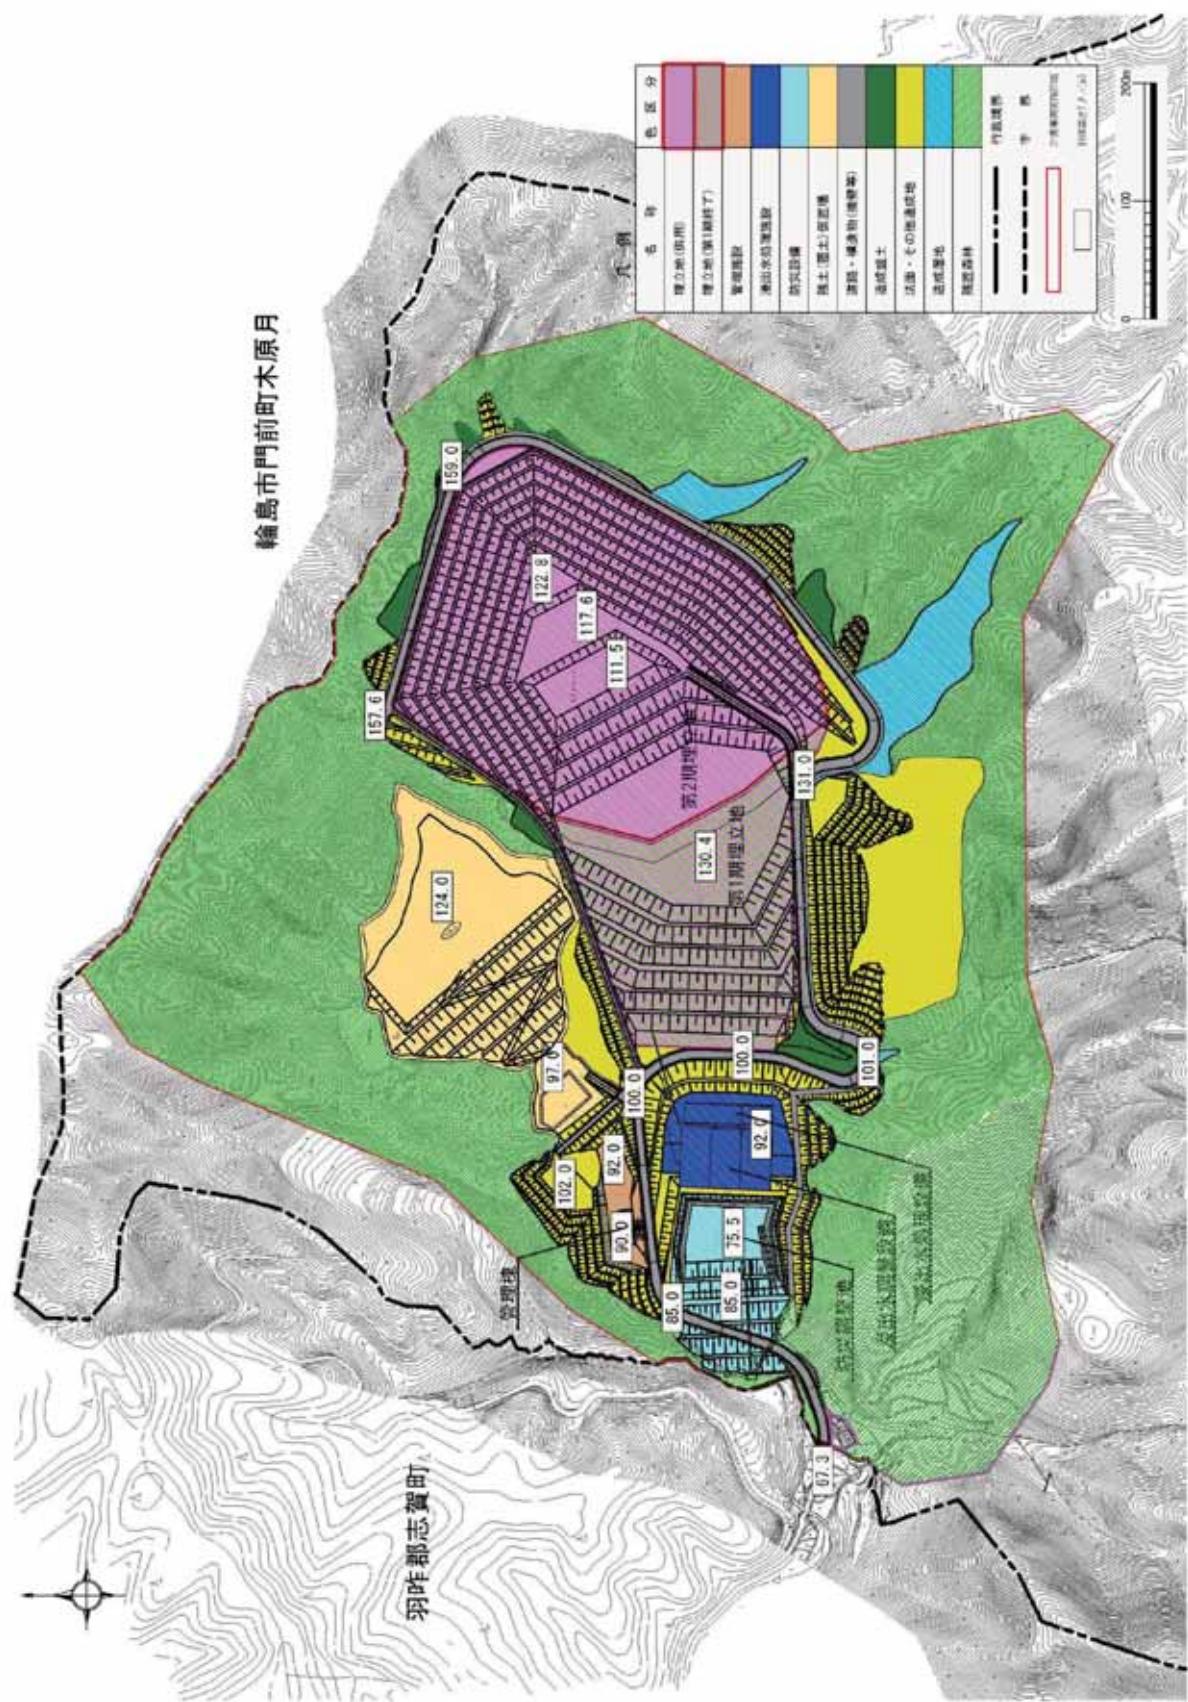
造成・施設配置計画平面図（第2期整備）
